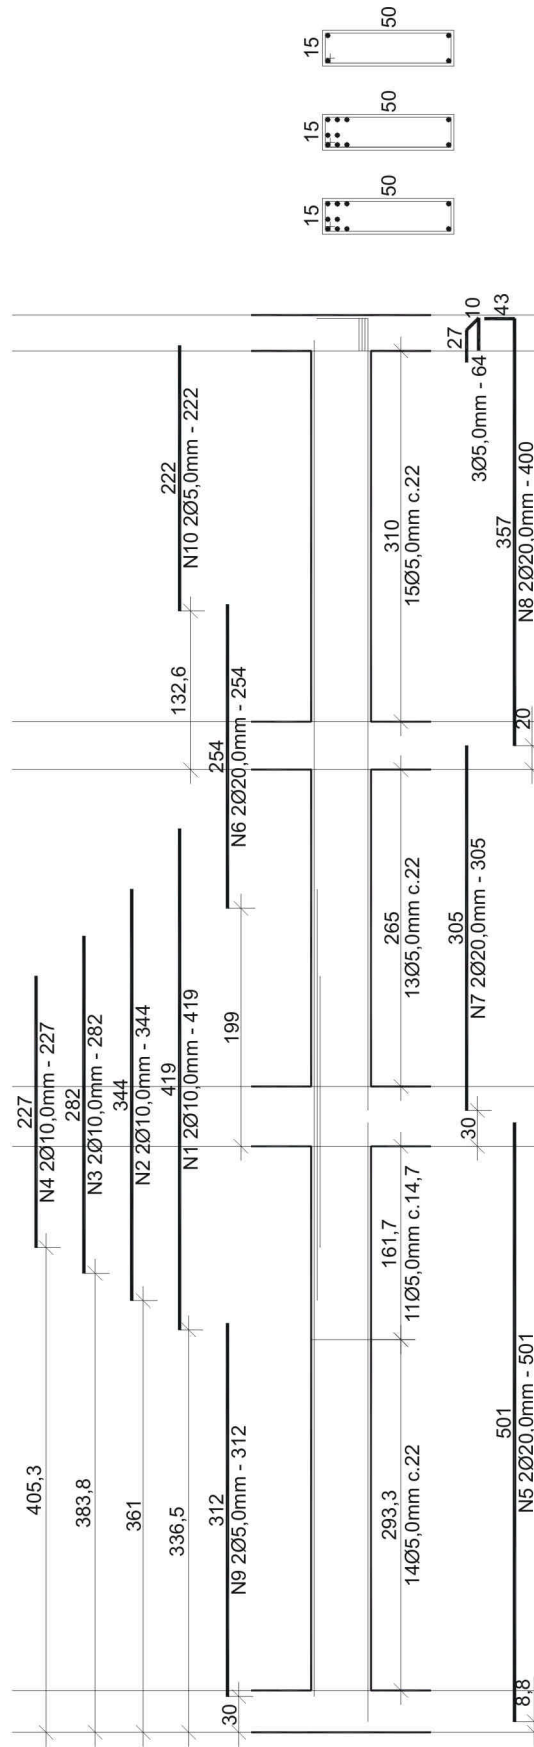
Detalhamento Viga 04.8, realizado pelo VigaCalc.
